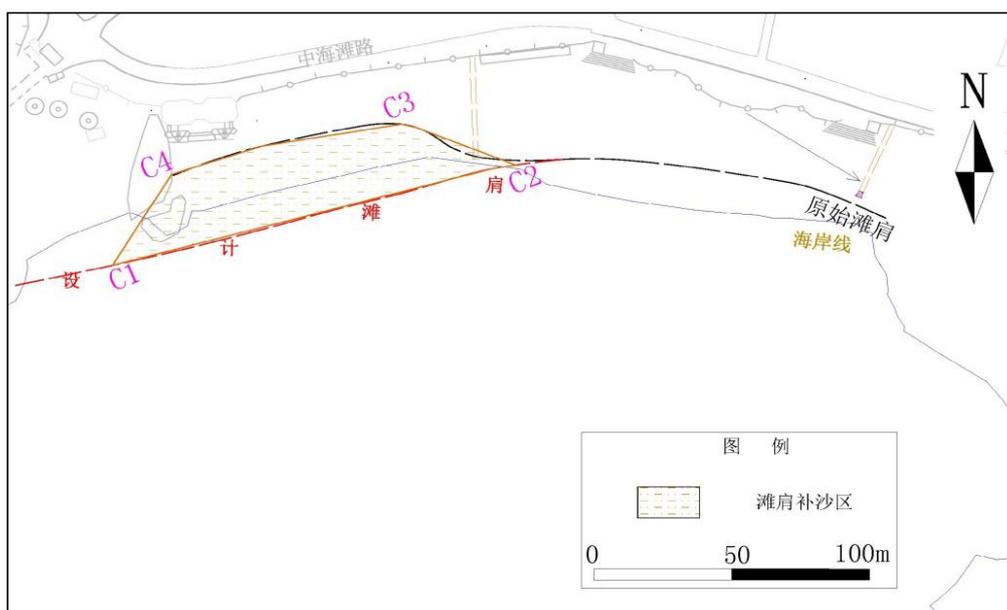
(b) 保二路入海排洪沟及周边岸线整治平面布置图
